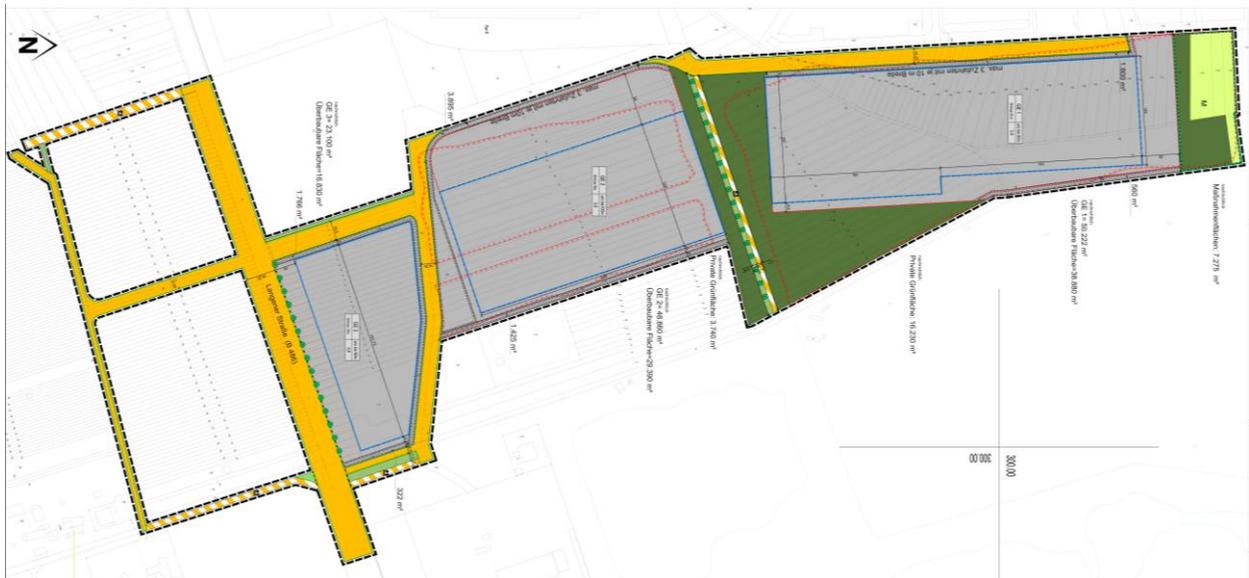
Ausschnitt Vorentwurf Bebauungsplan Nr. 54, Stadt Mörfelden-Walldorf, Stand 13.03.2024
